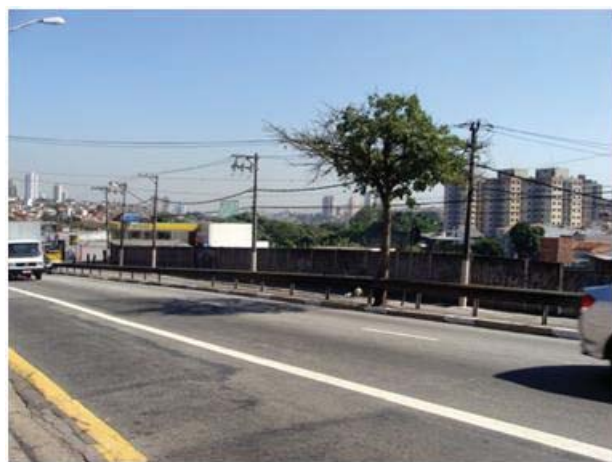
Vista da fachada do terreno onde será implantado o Terminal Ponte Rasa.
